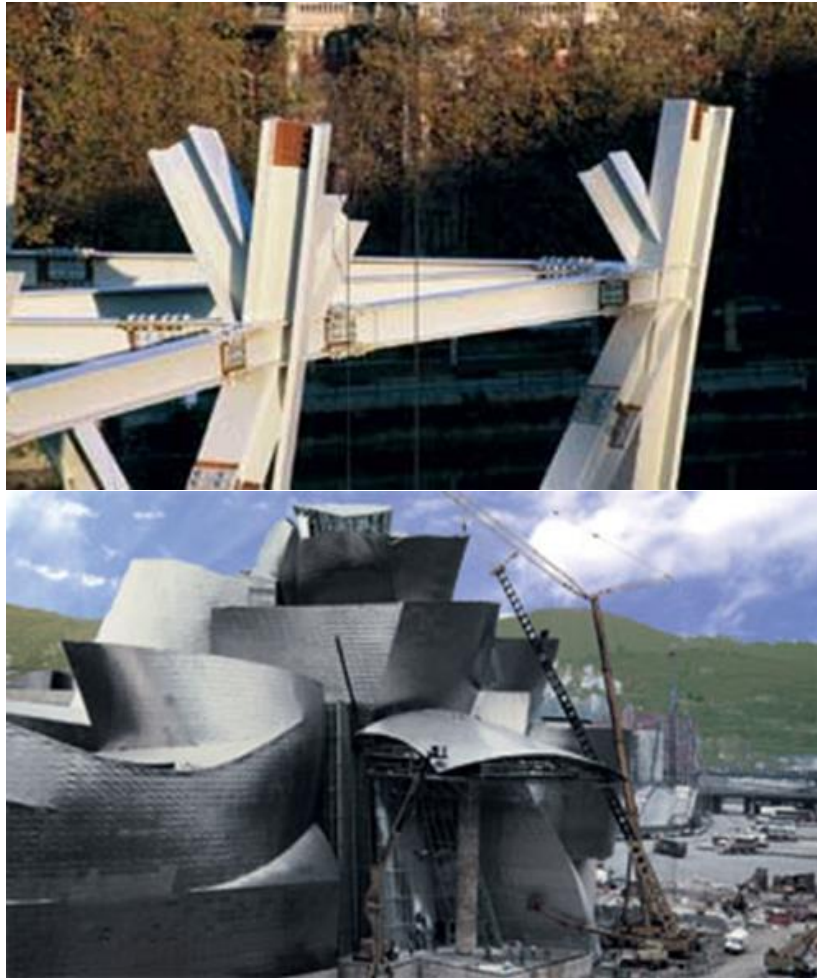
Detalhe e vista geral da fixação dos grampos de aço para reforço dos blocos de titânio da face externa.
